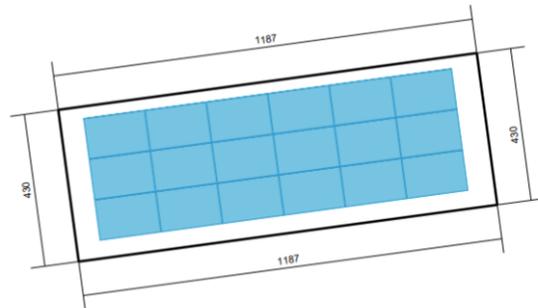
Dorfstrasse 20a, Belegungsplan, Dachfläche 1
